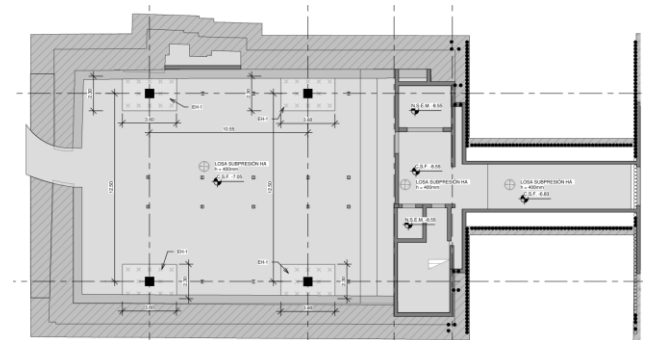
Planta de cimentación del ala Oeste y zona central del Arco.
